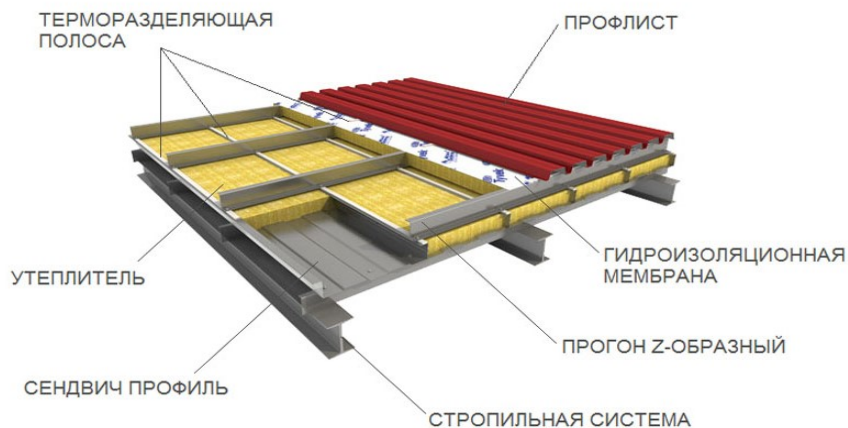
Конструкция кровельной панели поэлементной сборки
